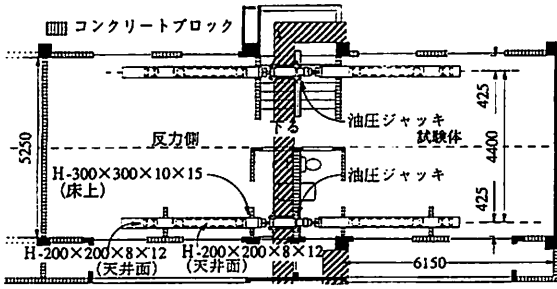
油圧ジャッキの取り付け位置 (2階, 3階平面図)
